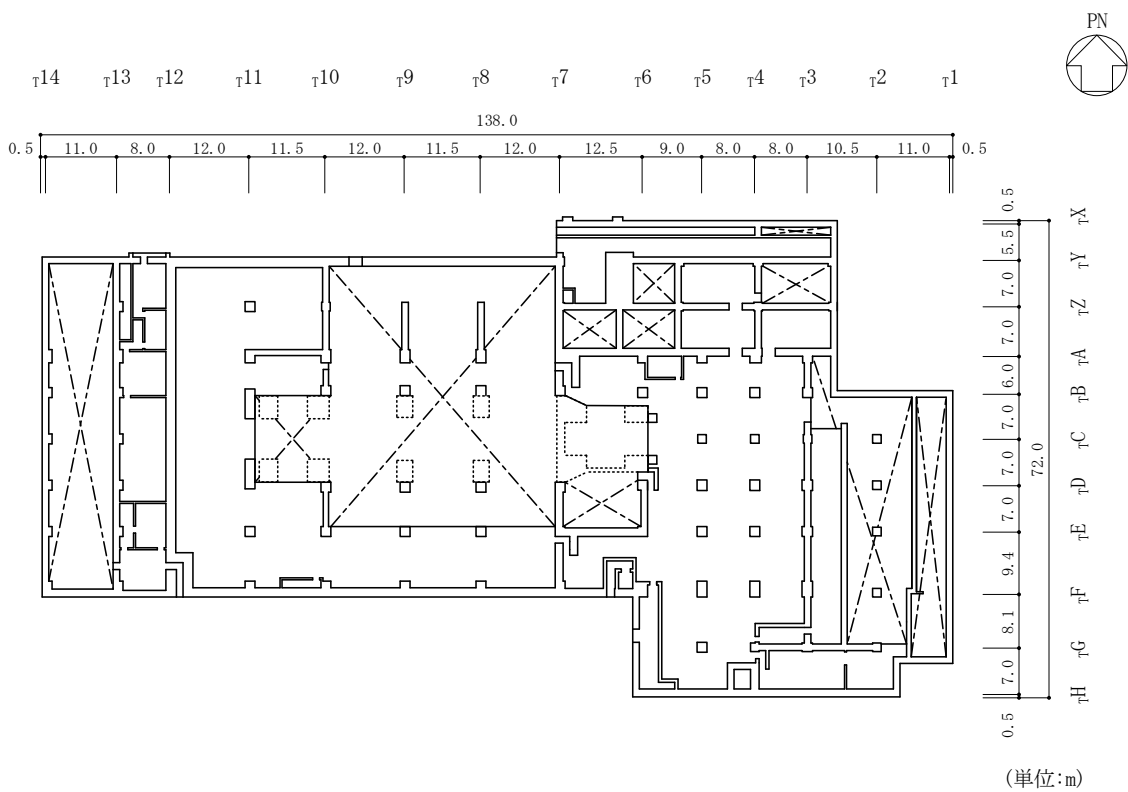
(2) タービン建物の概略平面図 (EL 5.5m)
